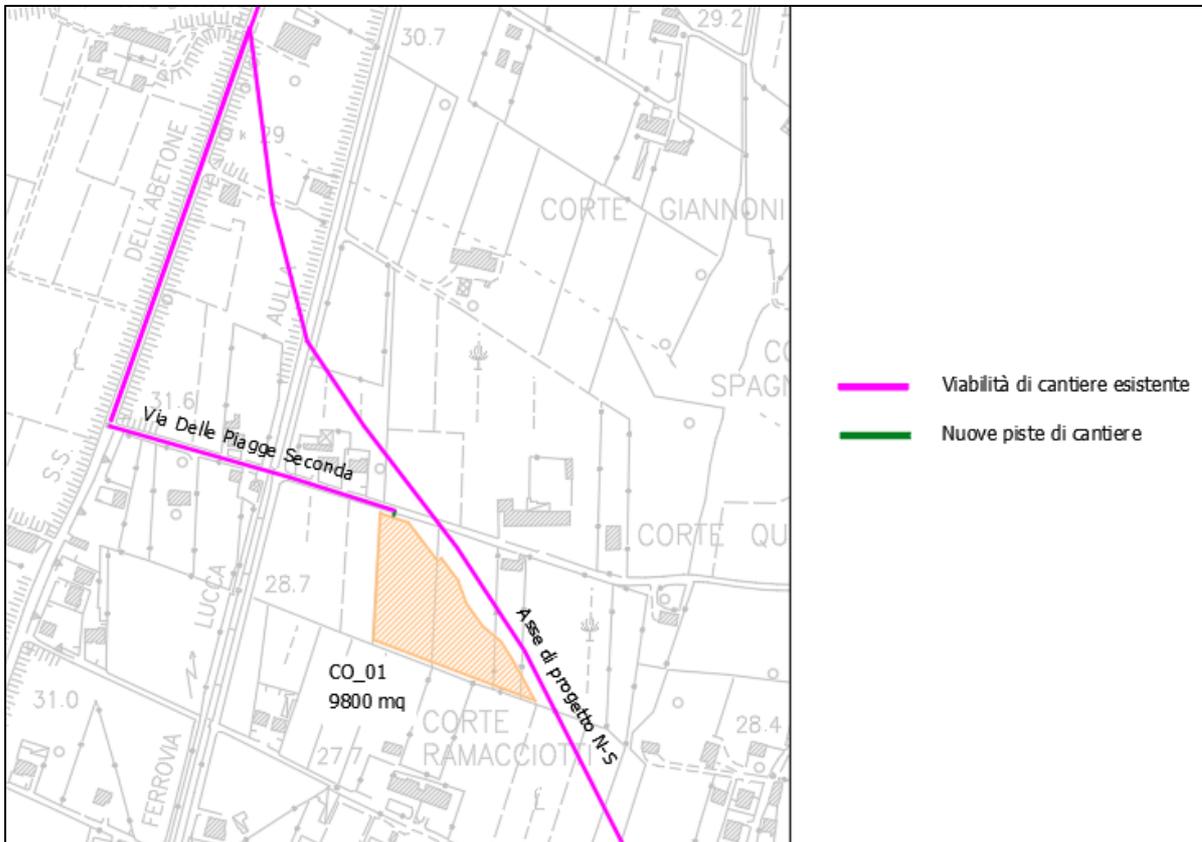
Collegamento tra SS12 e cantiere operativo CO_01 attraverso Via Delle Piagge Seconda
